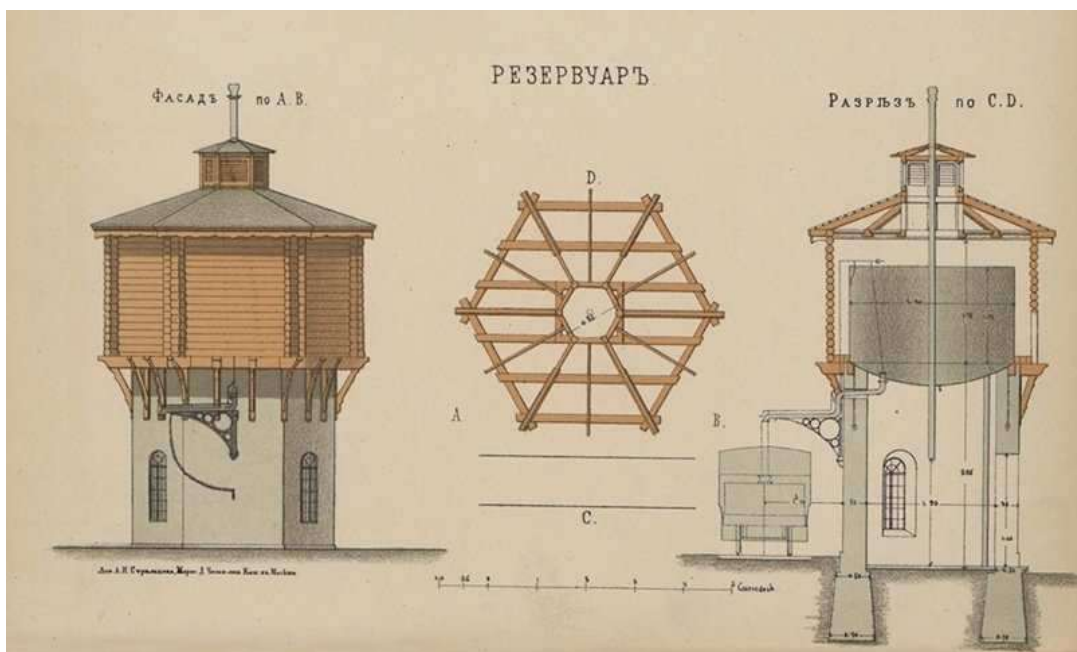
Фасад, план кровли и разрез башни на Плотинке
